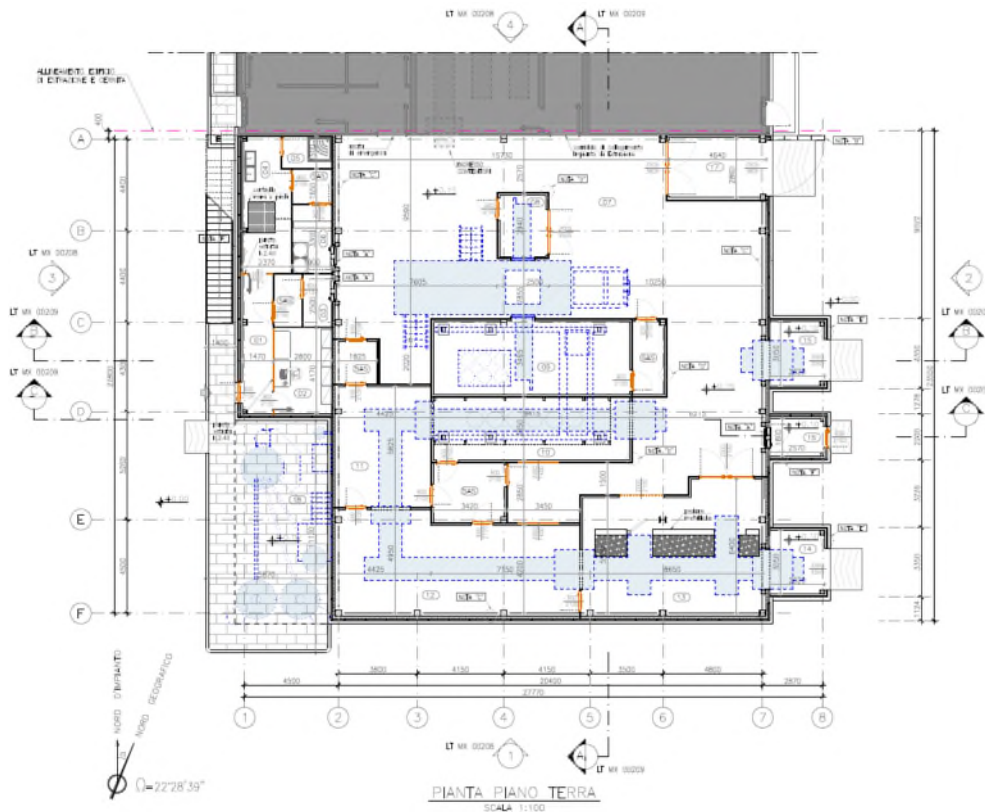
Pianta Edificio trattamento e condizionamento
